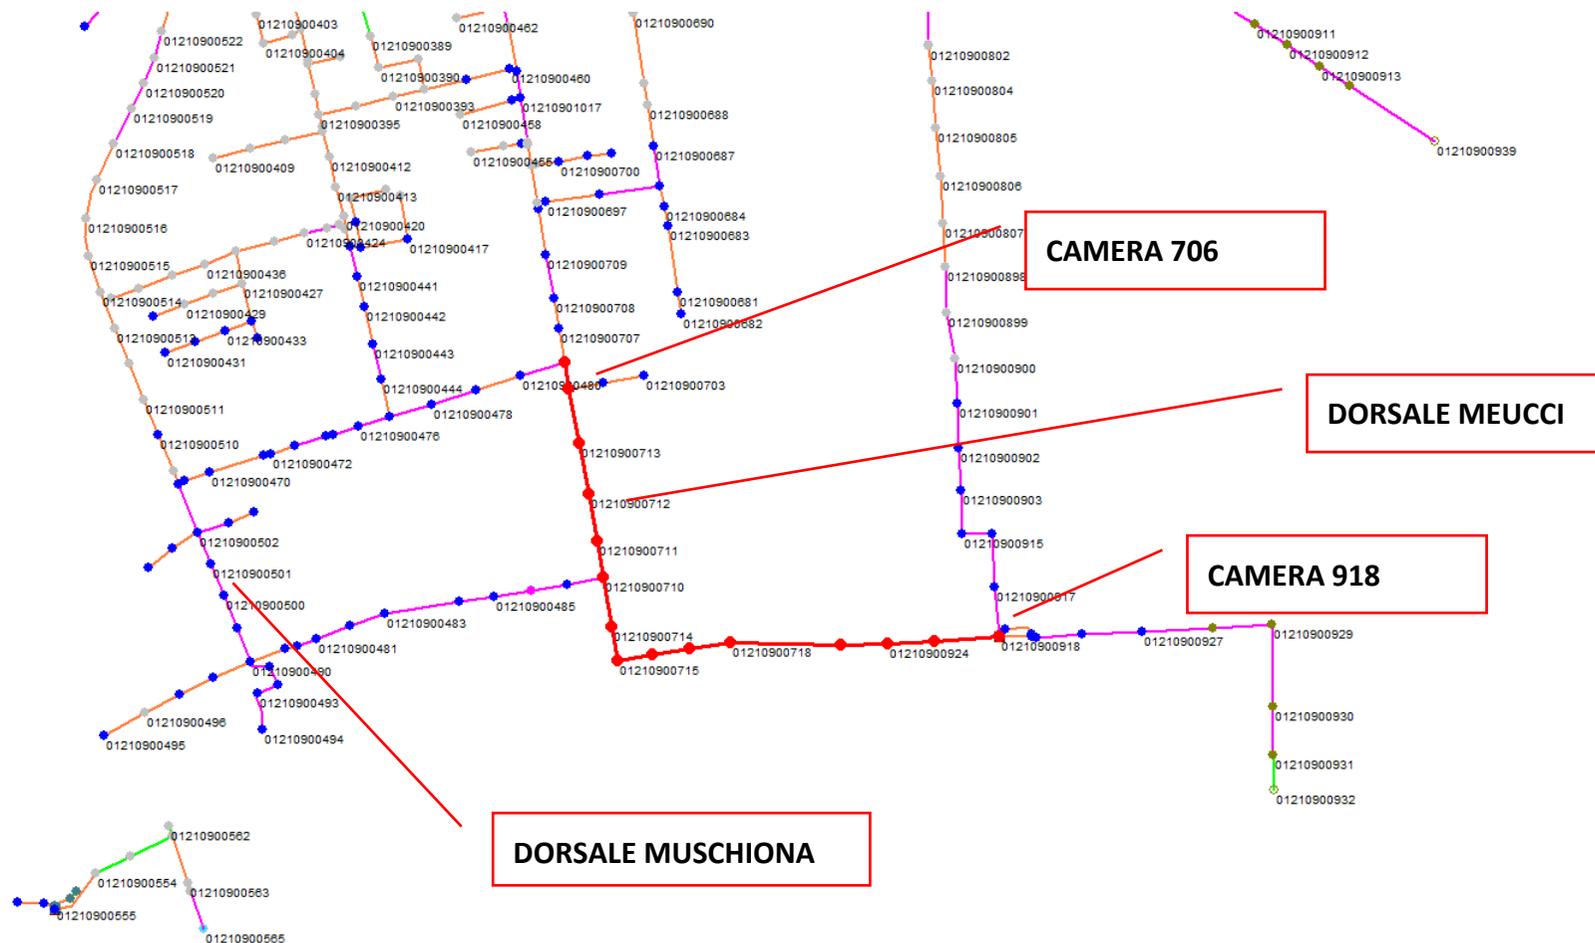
rappresentazione planimetrica del tratto di rete fognaria
